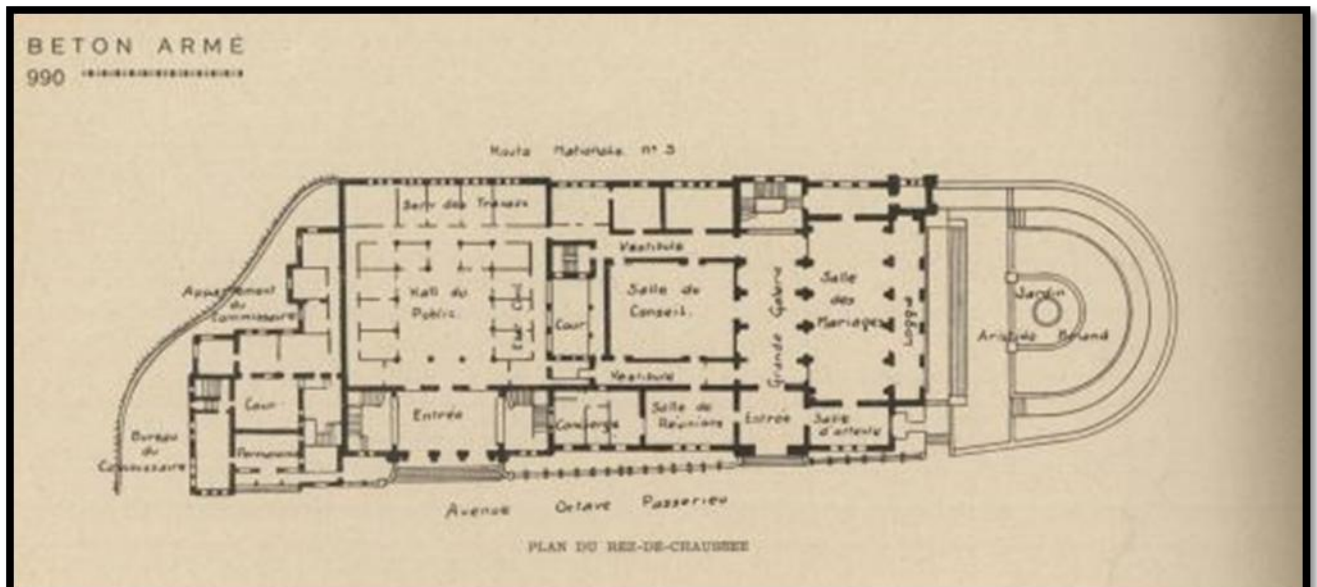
Plan du rez-de-chaussée, Hôtel de Ville de Philippeville. 1934.
